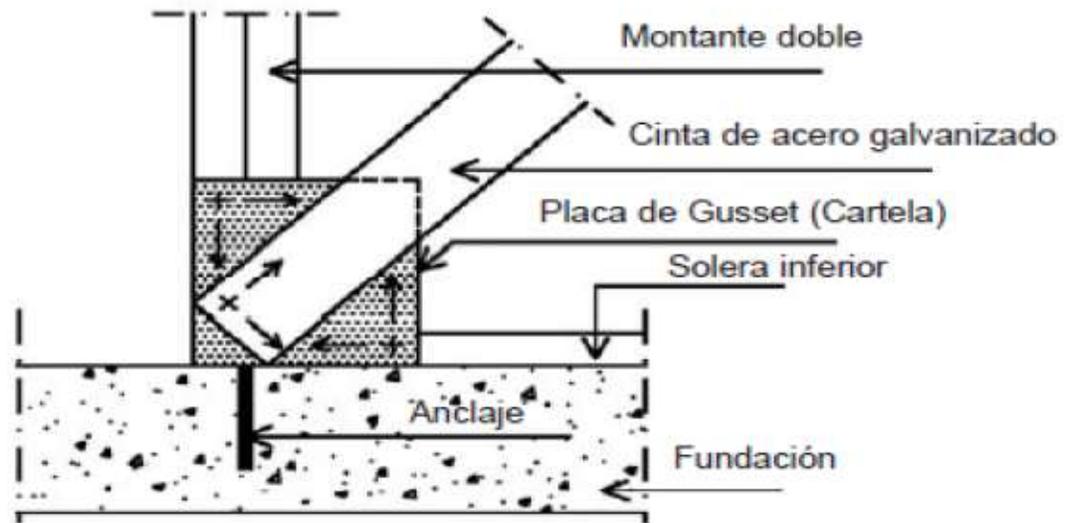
Fijación de las diagonales en los paneles con cartela.
